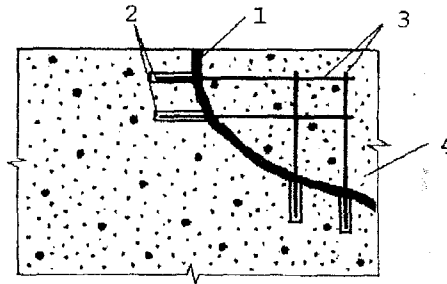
Ремонт бетонных конструкций с помощью клеев:
